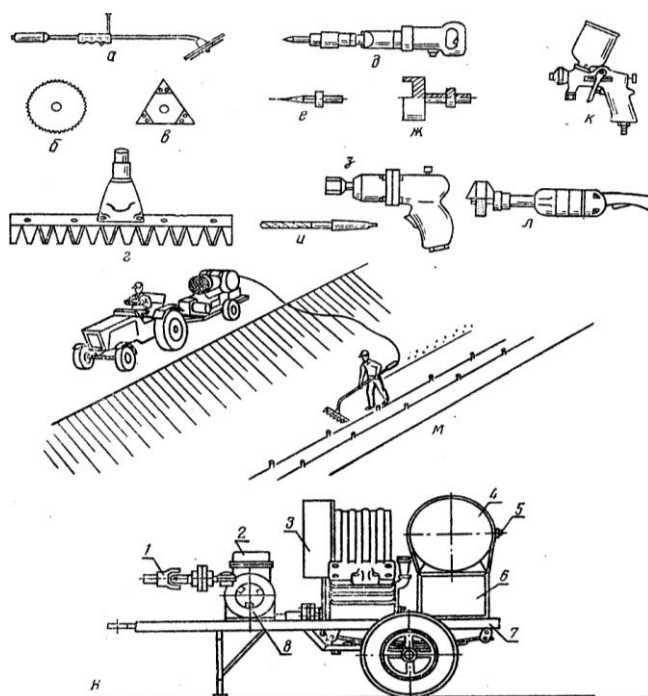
Комплектность и схема работы агрегата с пневматическим приводом механизированного инструмента: а – косилка; б, в, г – режущие насадки косилки; д – бетонолом; е, ж – наконечники бетонолома; з – пневмогайковерт; и – сверло; к – краскопульт; л – шлифовальная машина; м – схема работы; н – основной агрегат
